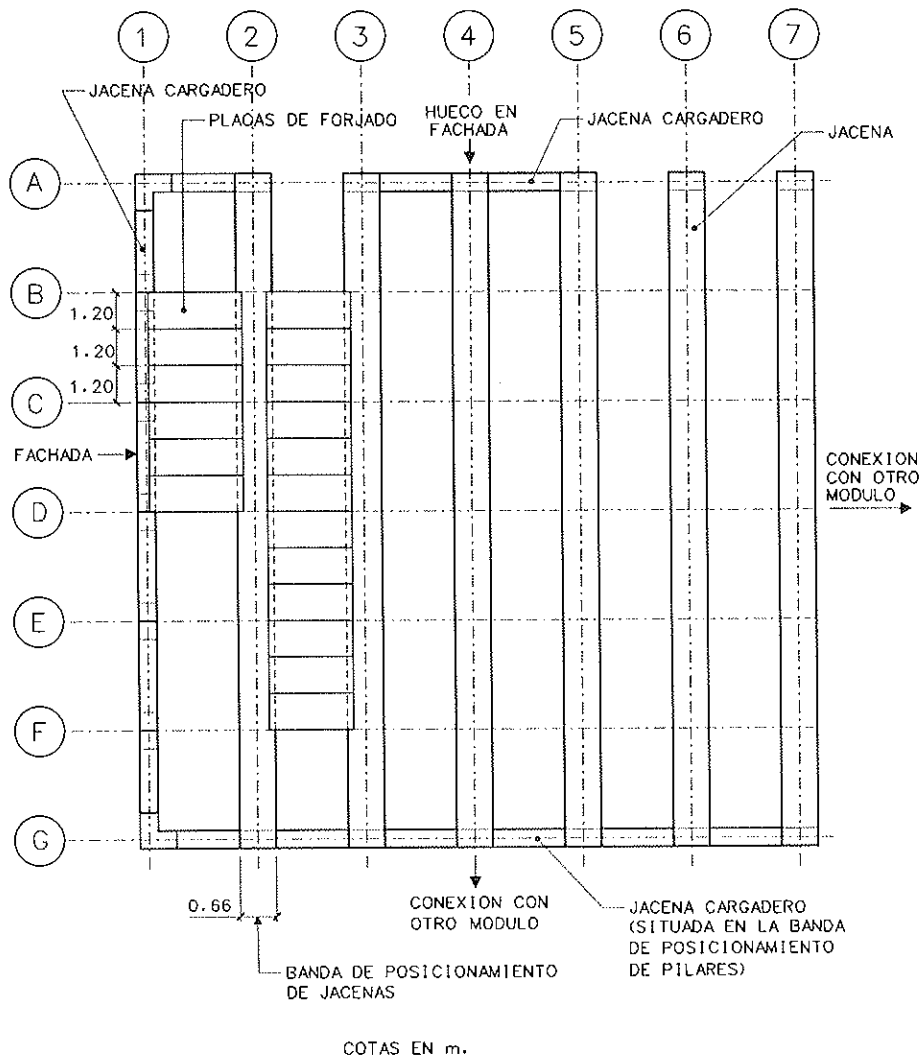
Posicionamiento de la estructura horizontal, en Planta.
